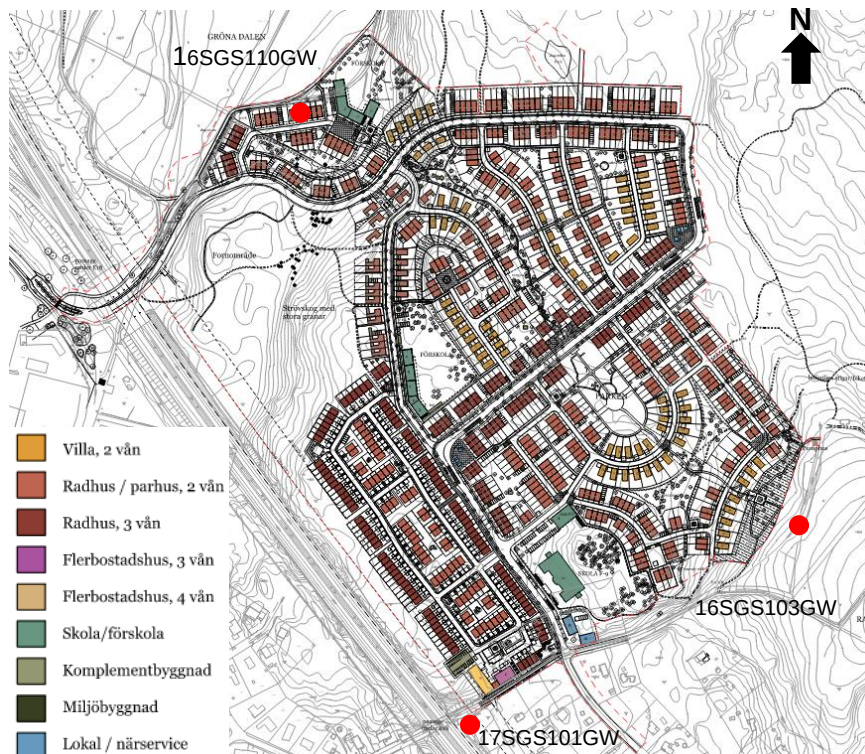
Ungefärlig placering av grundvattenrör hämtat från den geotekniska undersökningen etapp 1, Structor 2023-05-09. Strukturplan erhållen 2023-09-15.
